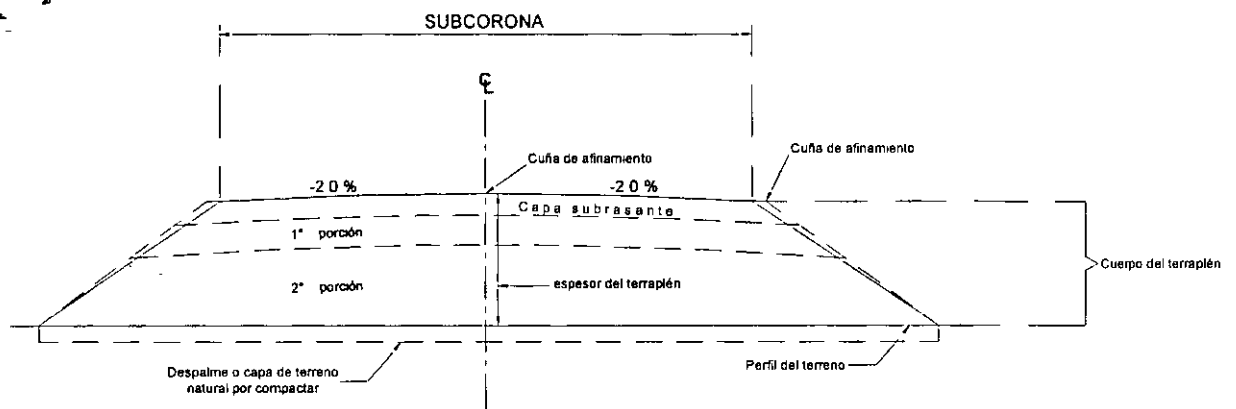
SECCIÓN DE CONSTRUCCIÓN DE UN TERRAPLÉN EN TANGENTE
